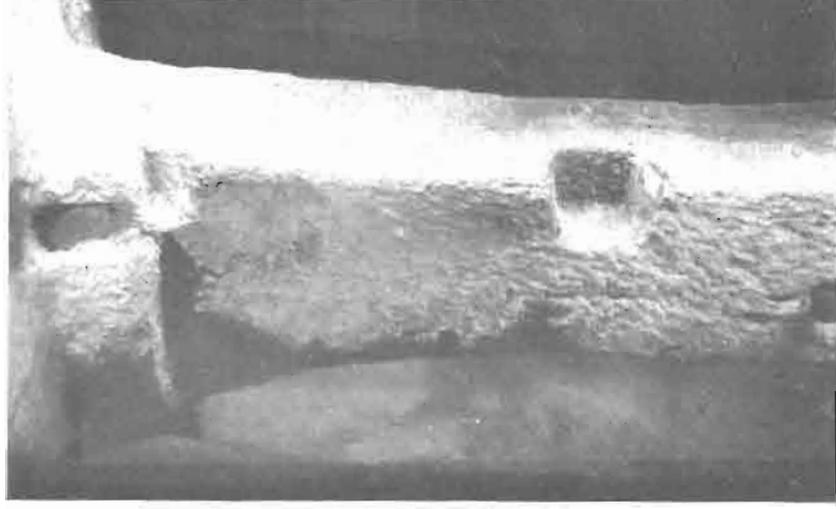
Arroyuelos. Parte superior del mismo pilar central.
